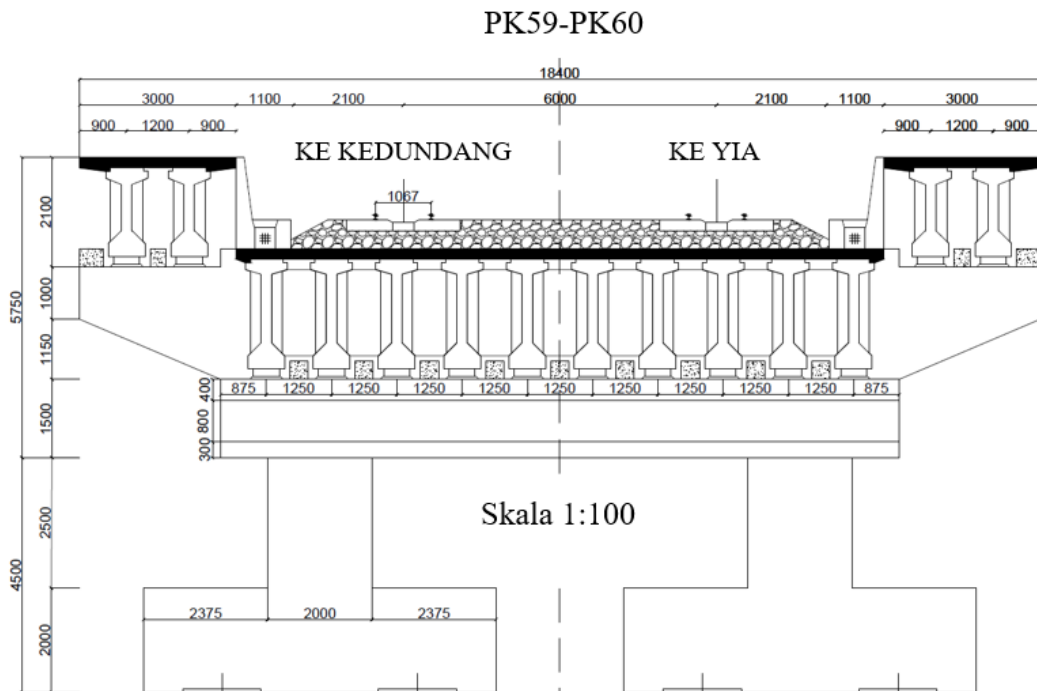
Potongan Memanjang Jembatan *PCI Girder* Jalur Kereta Api
